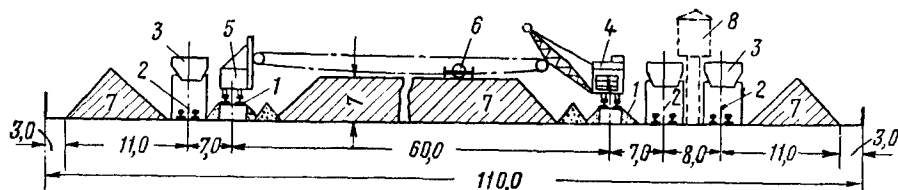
Поперечный разрез склада топлива, обслуживаемого кранами ПК-6: 1—разгрузочный путь; 2—экипировочные пути; 3—кустовые бункеры; 4—складские пути; 5—штабели угля
